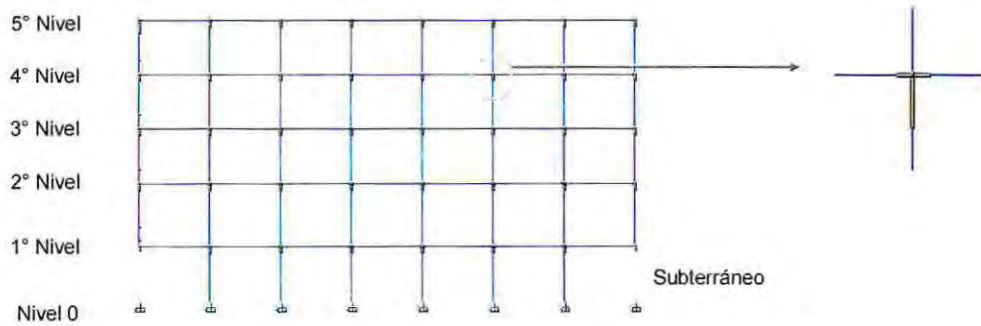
Modelación de elevación interior tipo y unión viga columna.
